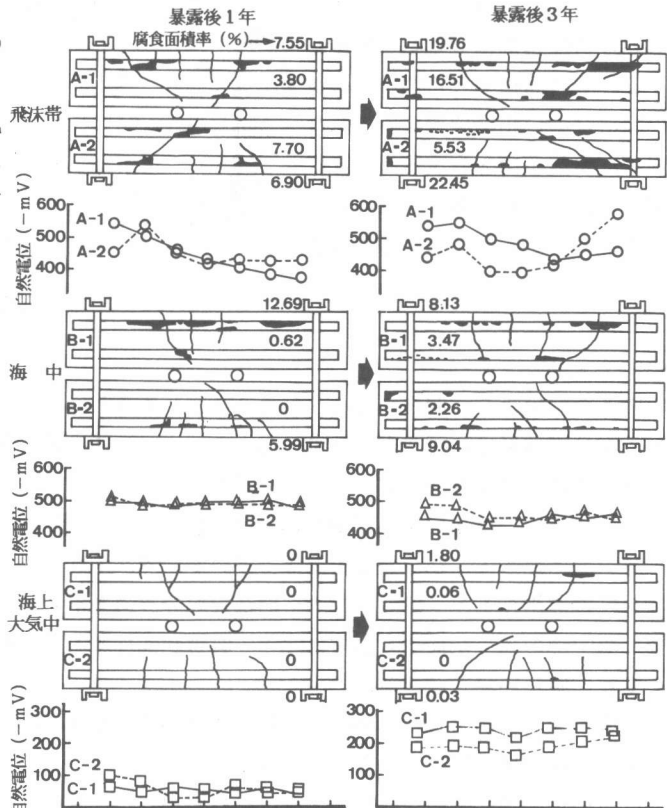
ひびわれがある供試体の鉄筋の腐食状況
